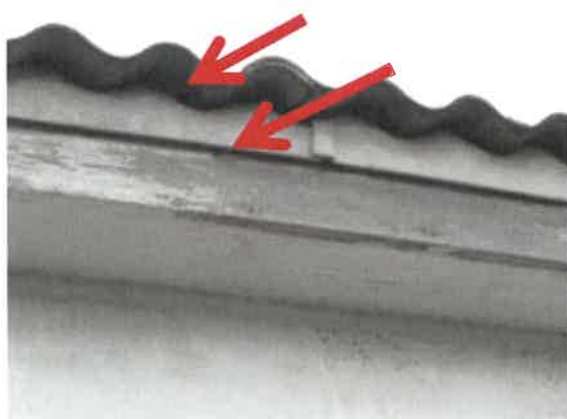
Gebäude 1 und 2: Dachüberstand mit Holzverkleidung u. Eternitleiste, Spalten vorhanden (s. Pfeile)
